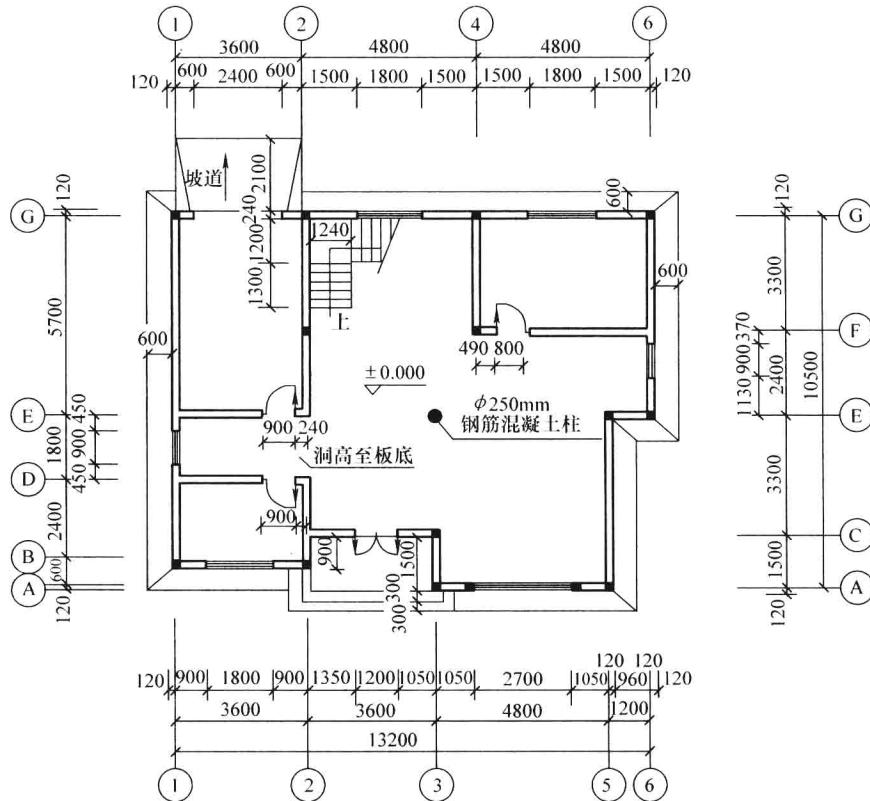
一层平面图（墙体厚 240mm，轴线居中）
